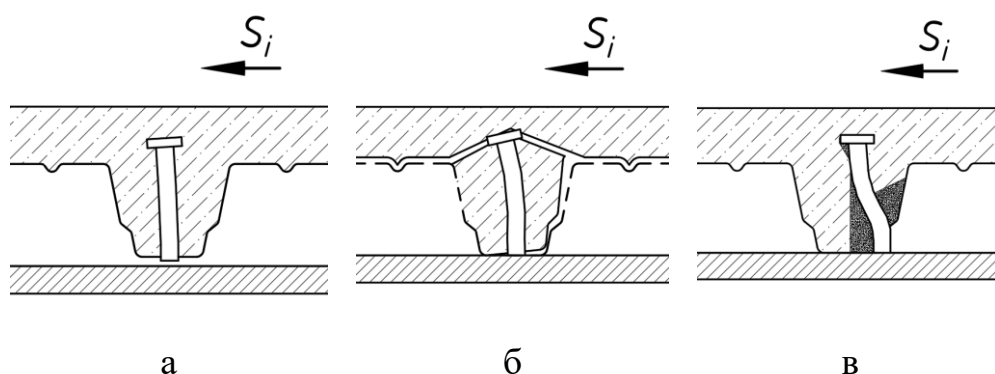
Наиболее характерные механизмы разрушения анкерных связей в сталежелезобетонных балках. а - срез анкерного упора; б - вырыв из бетона со срезом ребра; в - продавливание бетонного ребра;
